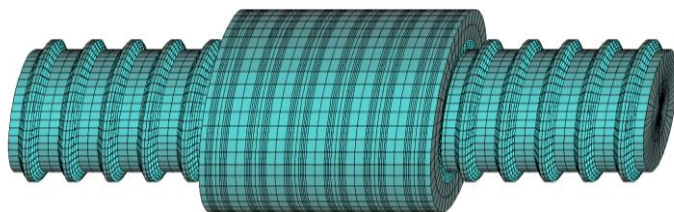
Расчетная модель узла арматурных стержней с винтовым профилем и с муфтой. Благодаря таким муфтам механическим путем создается усиление для стягивания одевающих подпорных стен с грунтом
